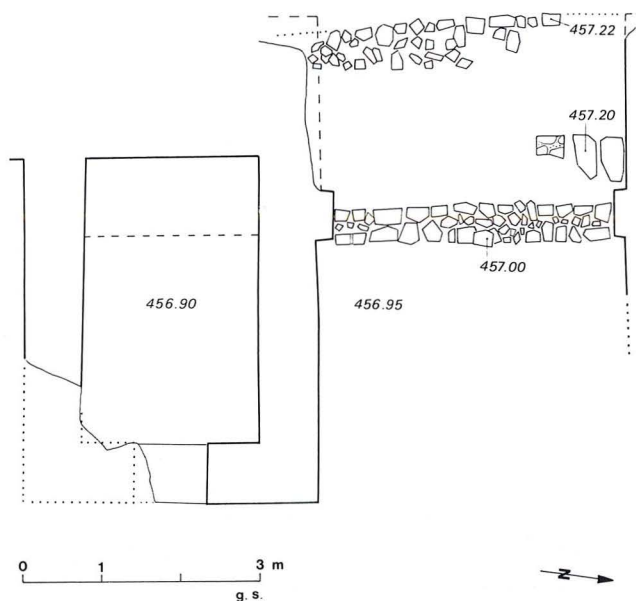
Porte ouest (sondage 4) : plan du 2ème état.
